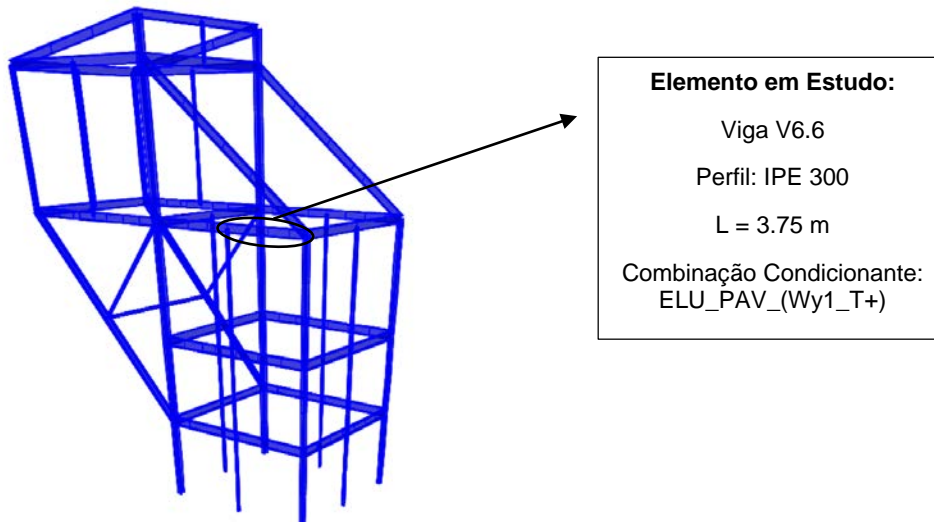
Localização da Viga V6.6 da Travessa do Pórtico 5
